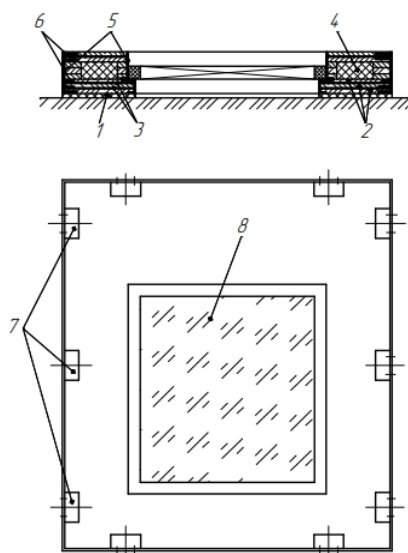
Конструкція будівельної панелі у металевому каркасі та з вбудованим вікном:
